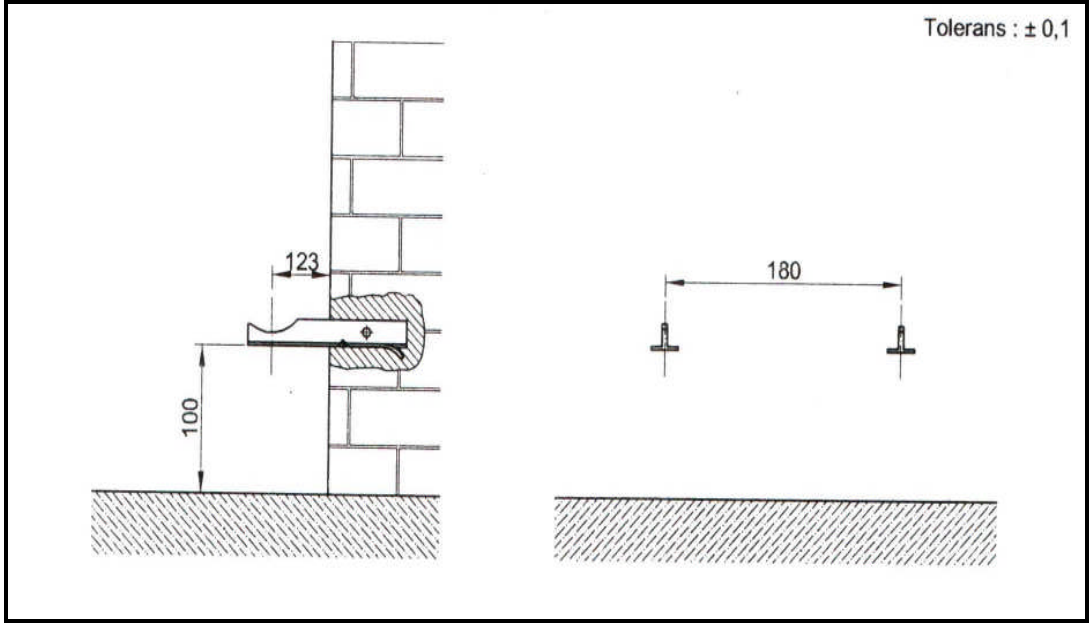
Radyatör keleçlerinin duvara montaj edilmesi
